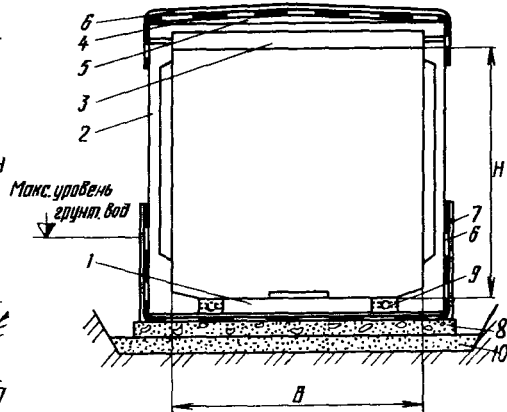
Коллектор из отдельных железобетонных элементов:
